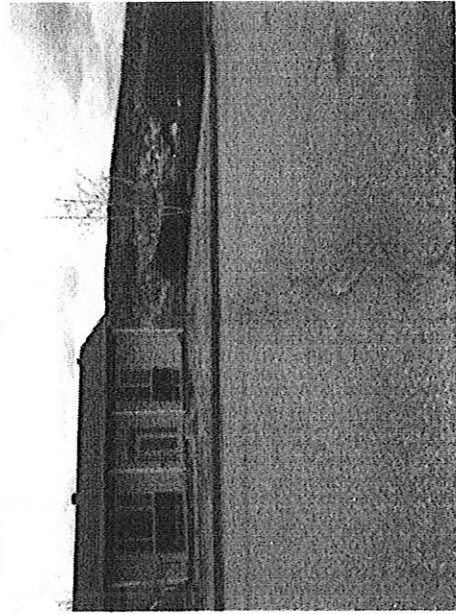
Ruisseau Lemelin à l'amont de l'entrée en canalisation
